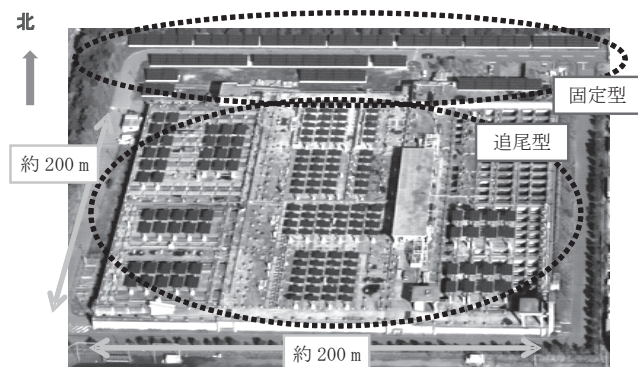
葛西水再生センター平面図（太陽光発電設備導入時）
